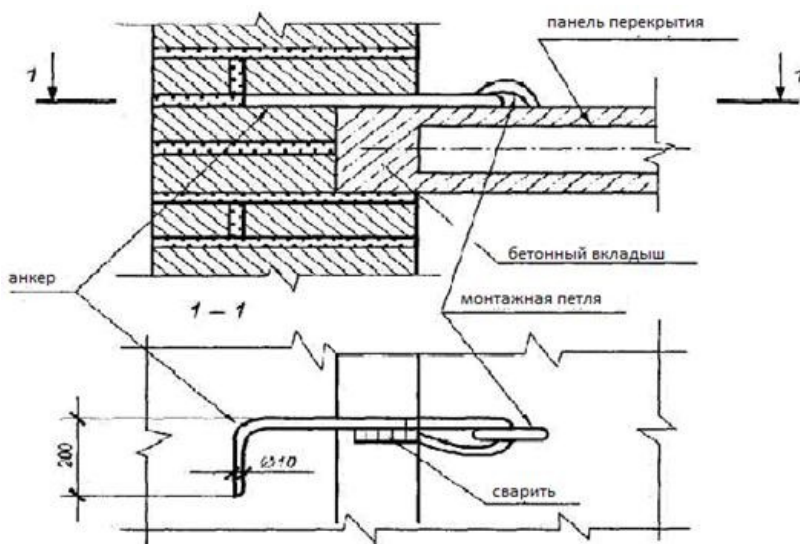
Крепление панели перекрытия в кирпичной стене
